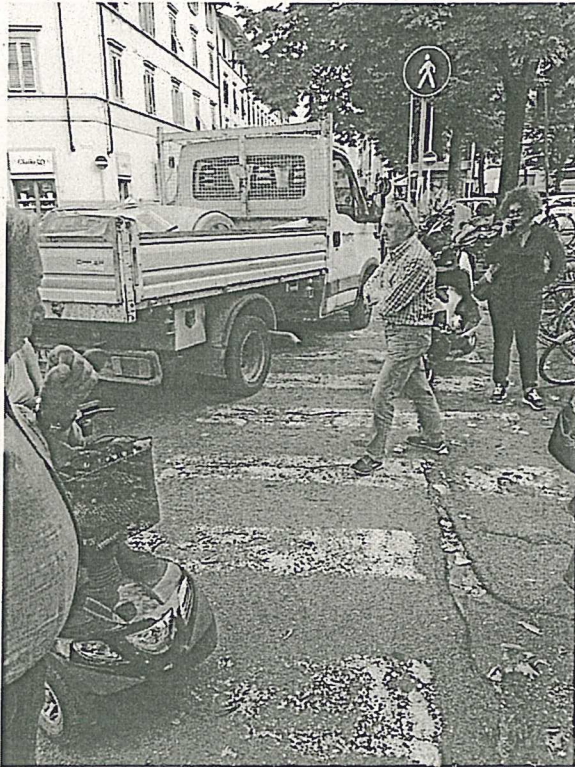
Attraversamenti pedonali Piazza Pier Vettori
